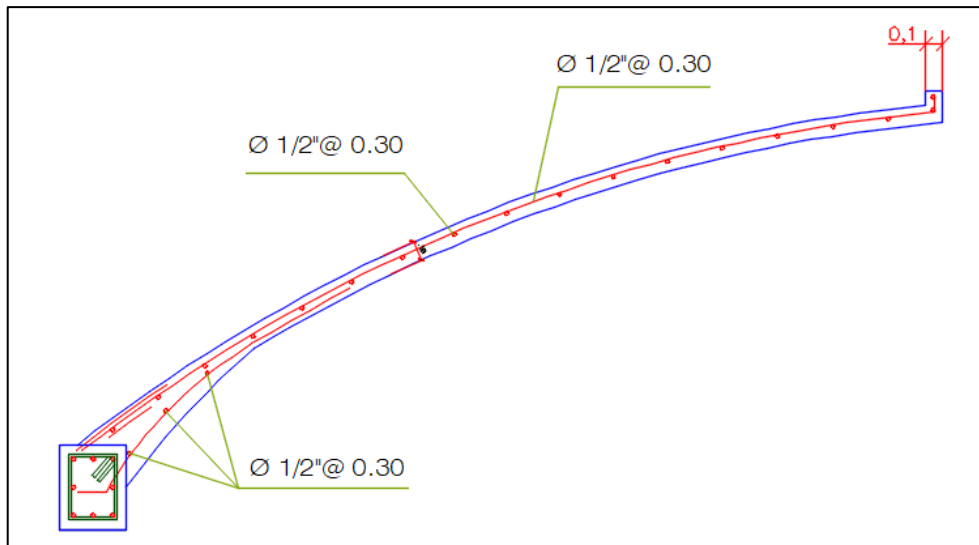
Plano de detalle de distribución de acero en la cúpula superior
